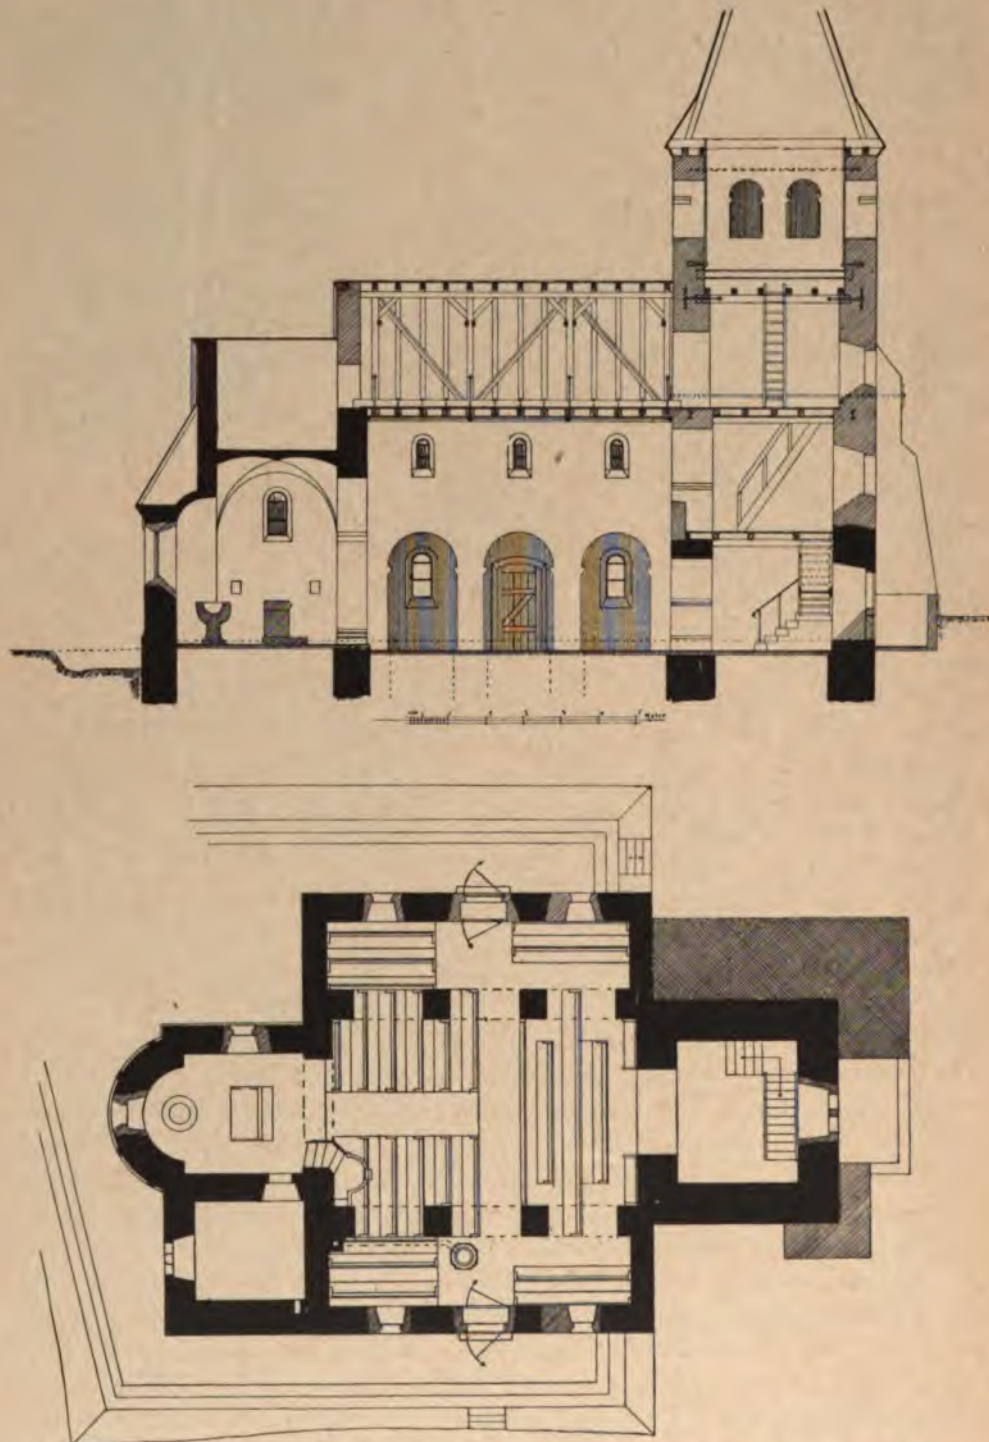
Kircheib, evang. Pfarrkirche. Längenschnitt und Grundriss nach der Wiederherstellung.
